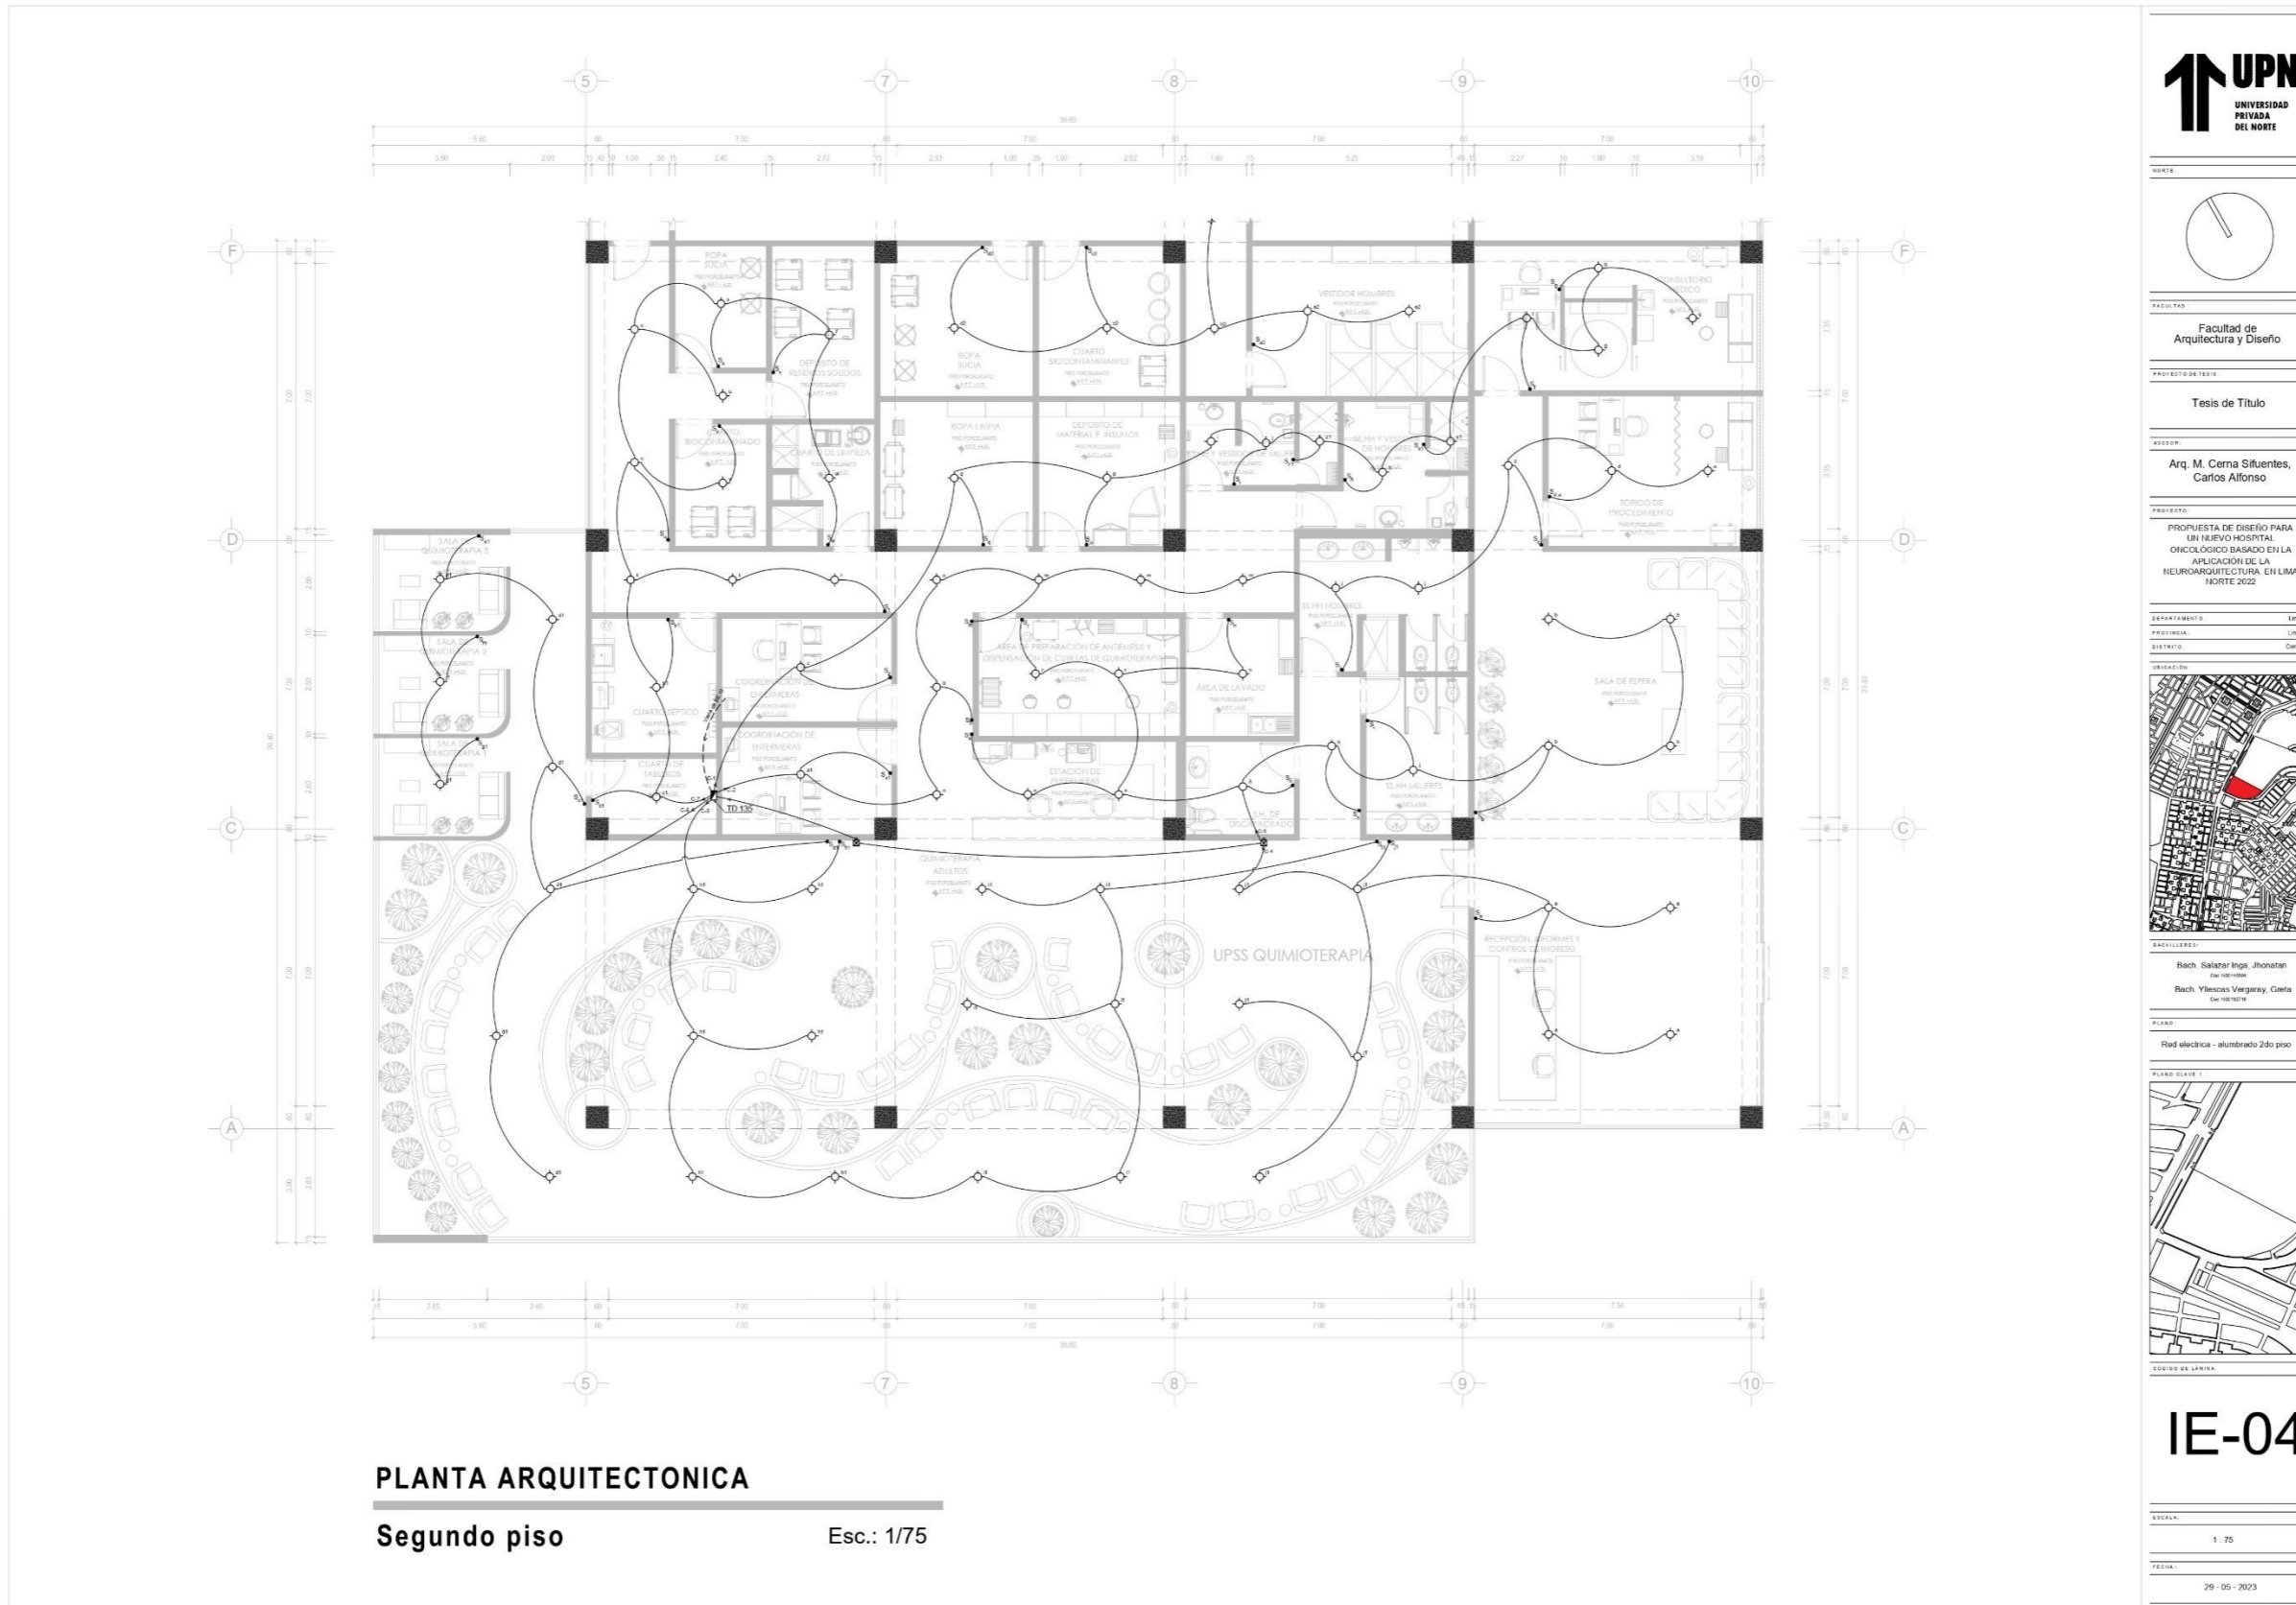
Instalaciones Eléctricas – Alumbrado nivel N°2 del sector cuadrante Esc: 1/75 (Fuente: Elaboración propia de los coautores)
